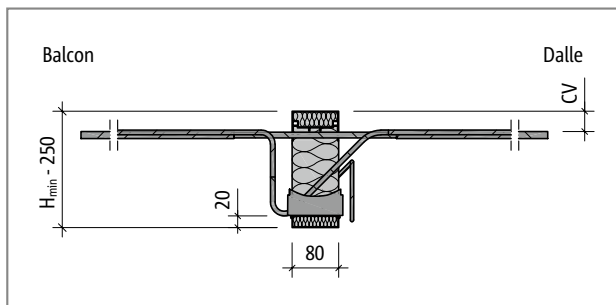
Schöck Isokorb® T Type K-E-M6, K-T-M7, -M9, -M10 : Coupe du produit
